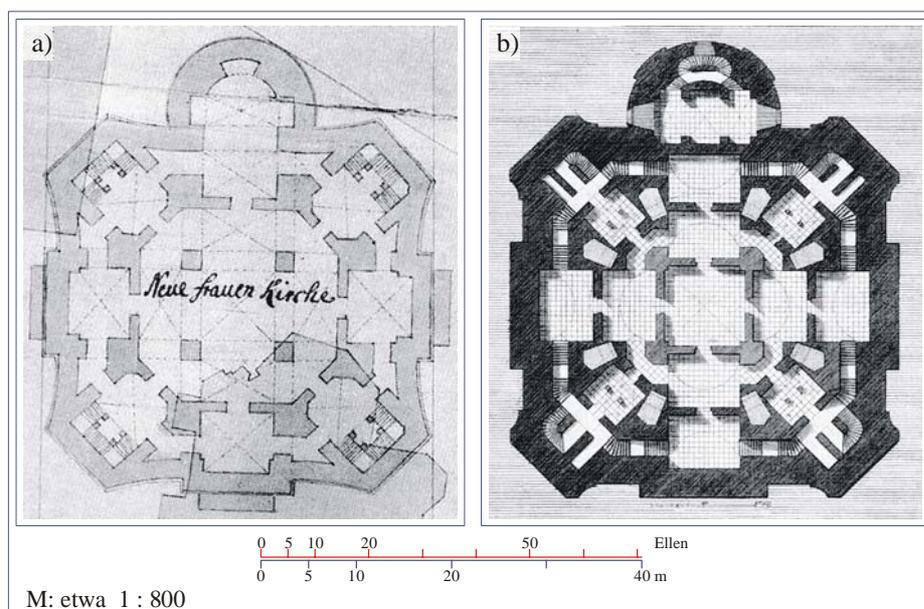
Verstärkung des gesamten Mauerwerkescörpers im Gruftgeschoß (Kellergeschoß) nach Erteilung der Baugenehmigung
